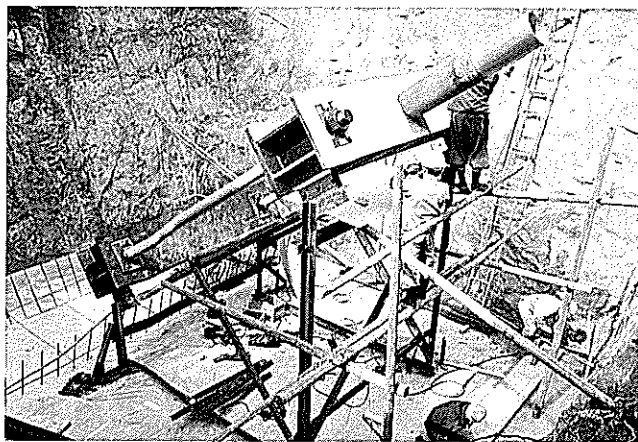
ケーブルアンカーフレーム（C1ケーブル）
